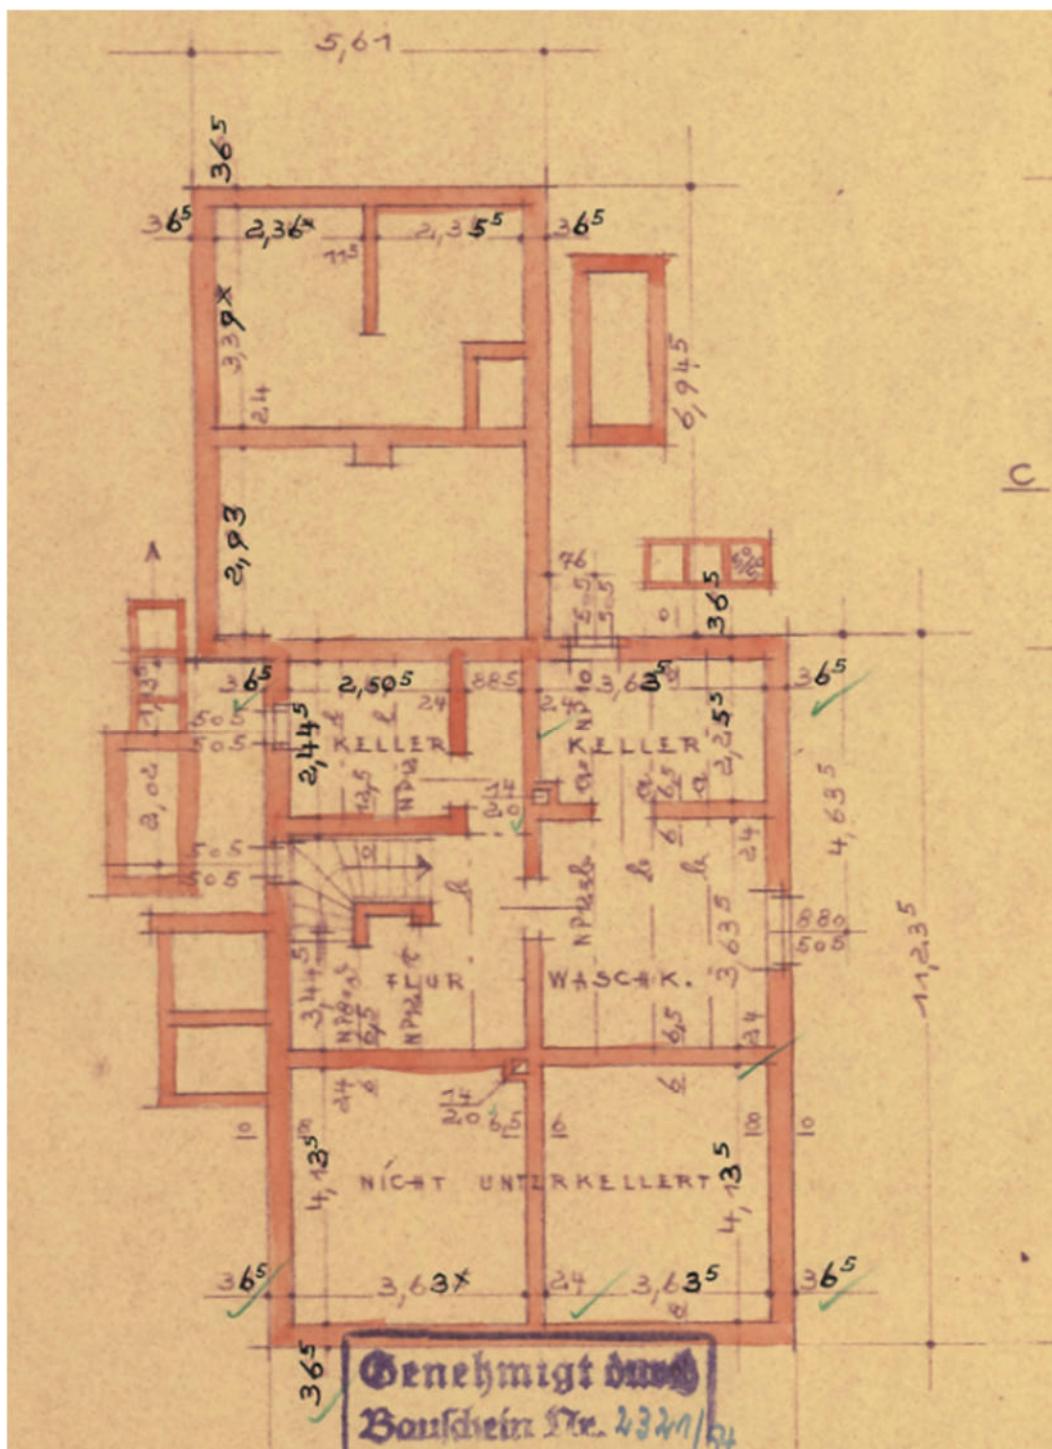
Kellergeschoß / Plan aus der Bauakte Abweichungen vor Ort sind möglich
